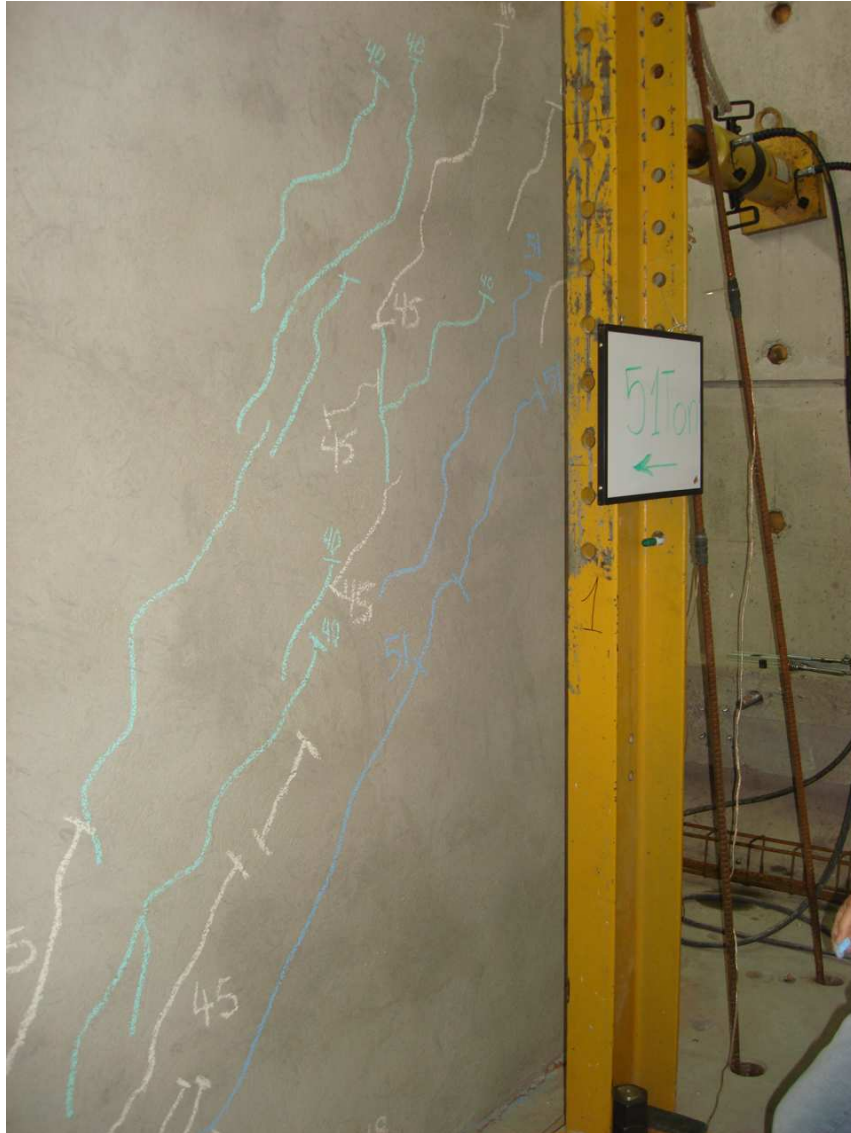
Fisuras en la pared a las 40 t de carga positiva
